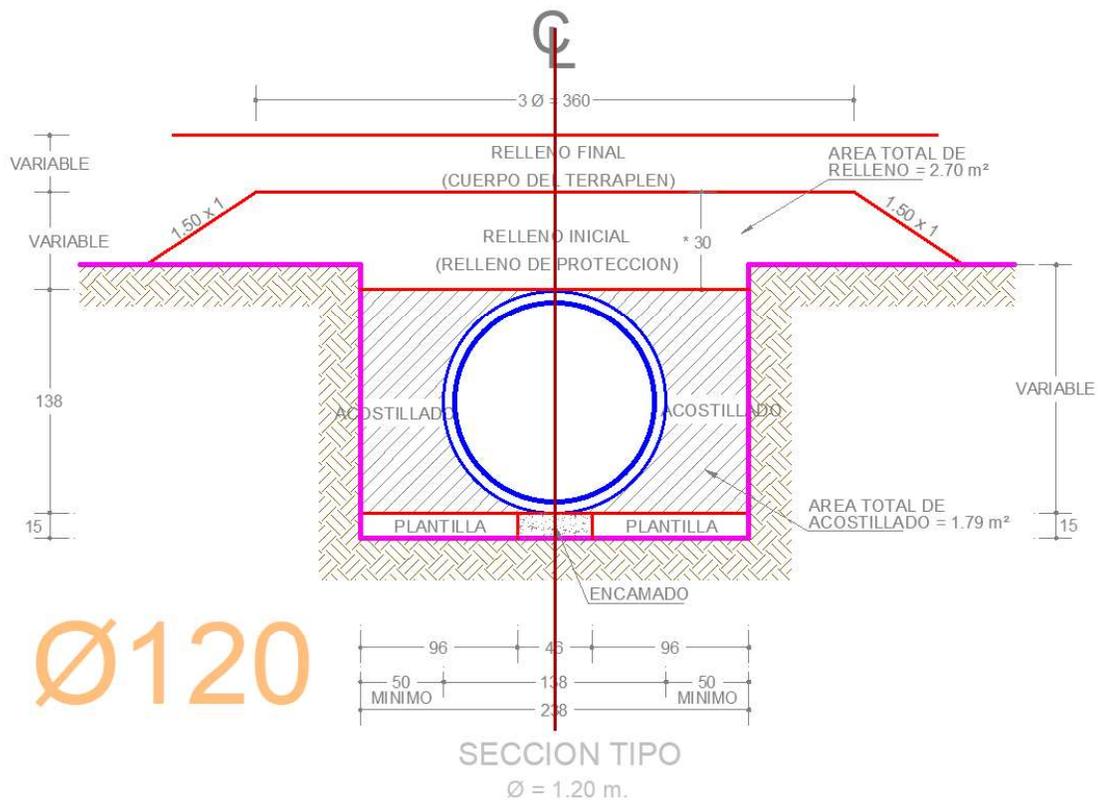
Sección tipo para tubo de concreto de 1.20 \varnothing
